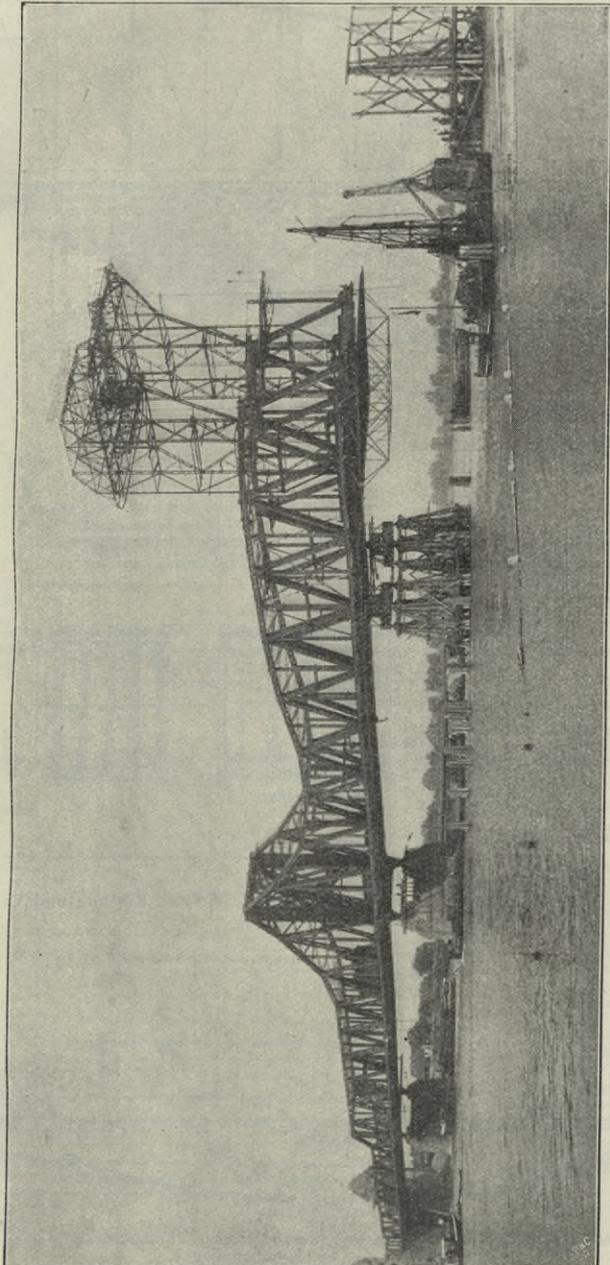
Montage der Mittelöffnung der Rheinbrücke Ruhrort-Homberg. D. B. Z. 1907, S. 657.
